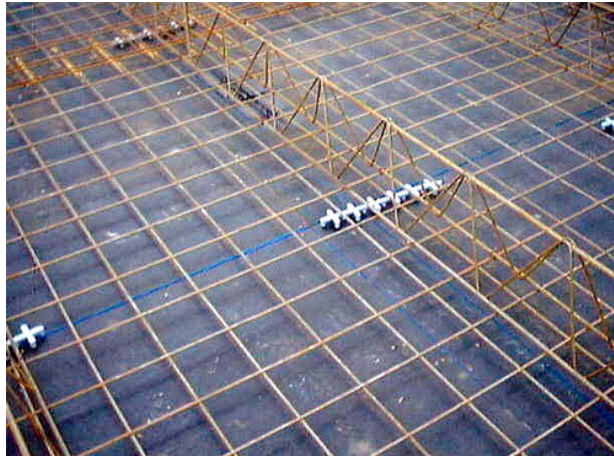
Exemplo de posicionamento da armadura utilizando espaçadores metálicos (www.engeprot.com.br).
